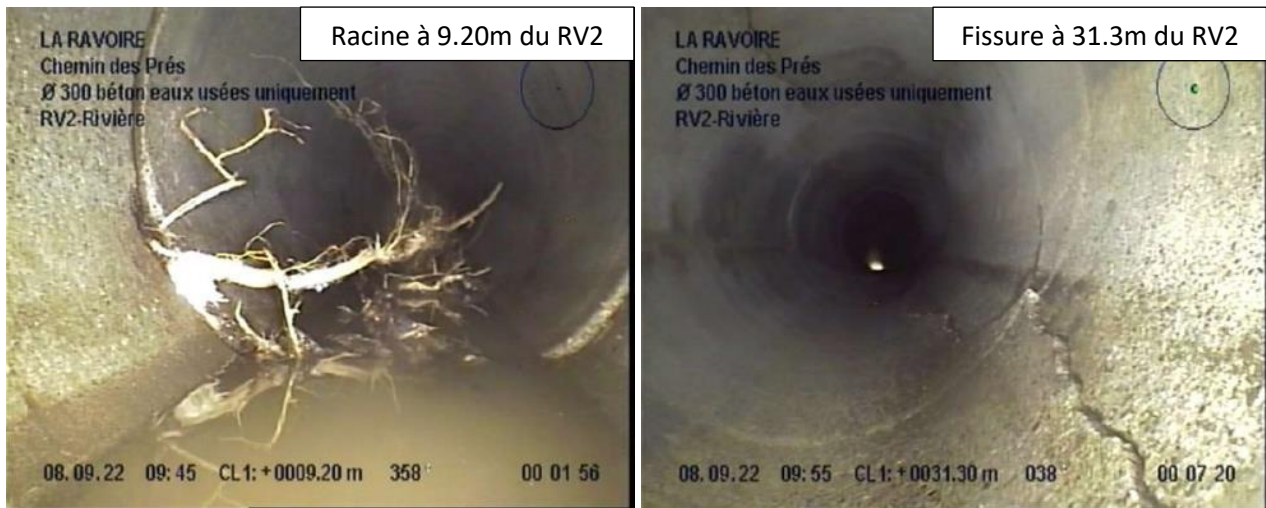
Photo de l'ITV de la conduite déversante du DO\_La-Ravoire
